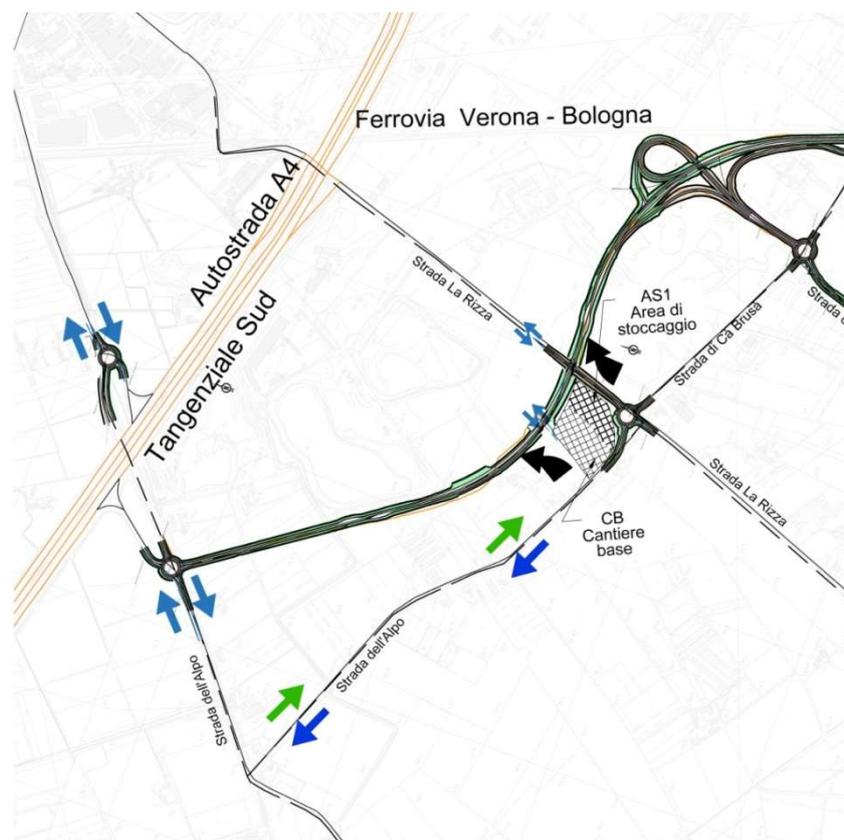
Stralcio 21-003_T00CA00CANPL01_A - Planimetria aree e viabilità di cantiere
